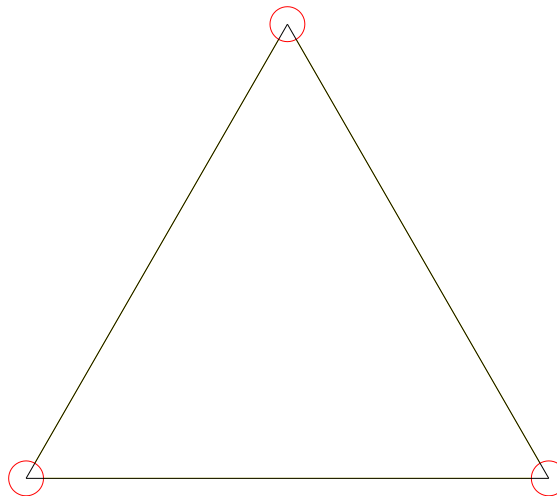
Planta de torre de sección triangular con montantes de perfil tubular.
